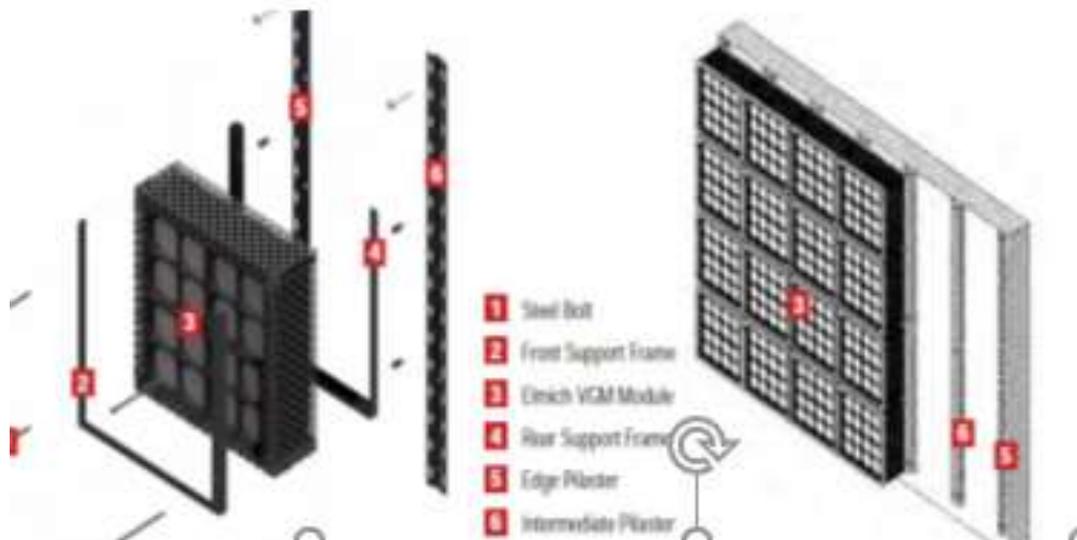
VGM Green Wall. 1-Pasadores de acero, 2-Marco frontal, 3-Módulos de polipropileno, 4-Marco posterior, 5-Perfil vertical de borde y 6-Perfil vertical intermedio.
